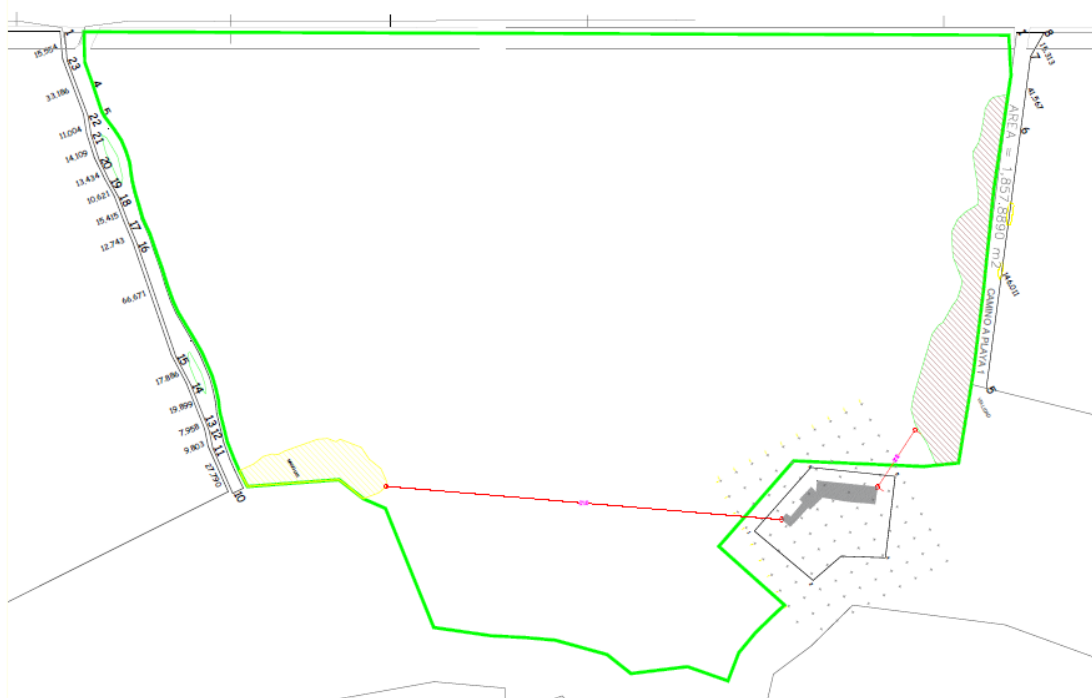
Distancia de las obras permanentes del proyecto con el manglar más cercano.
